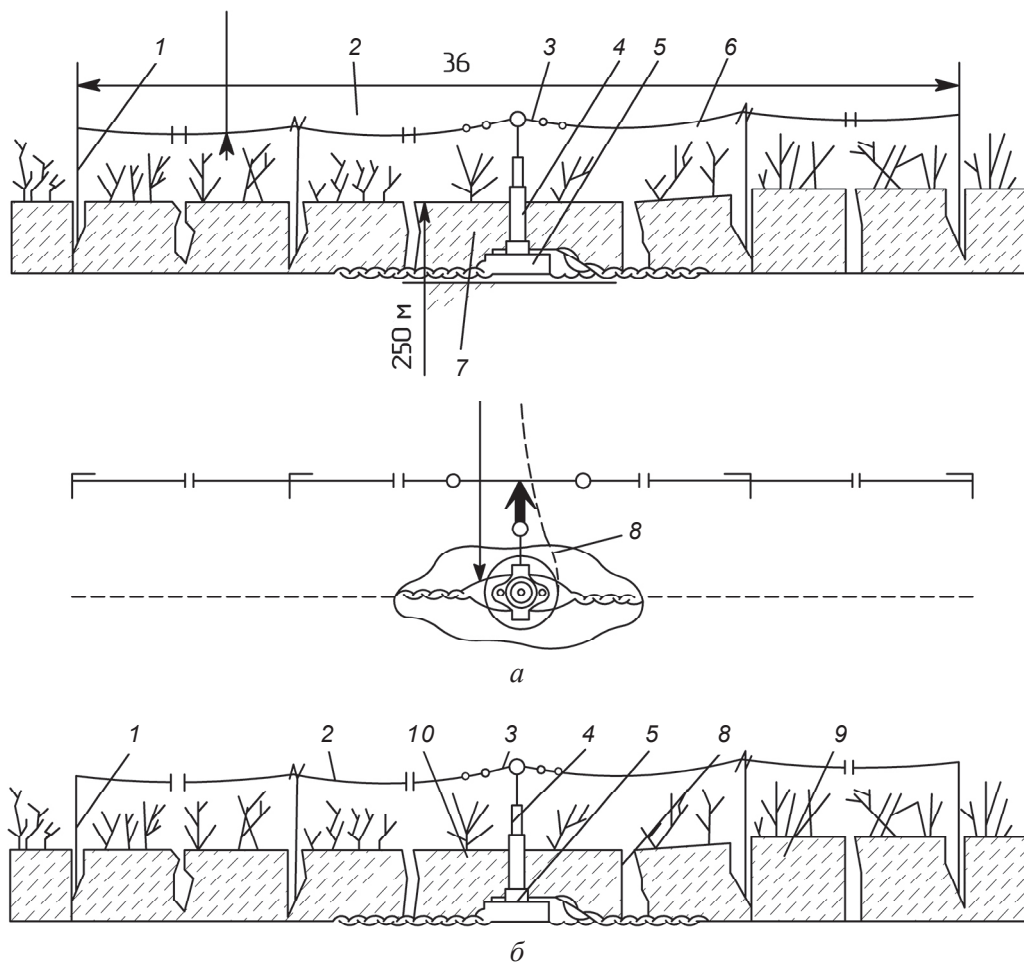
Установка исполнительного прибора [4, кн. 3, с. 179]:
